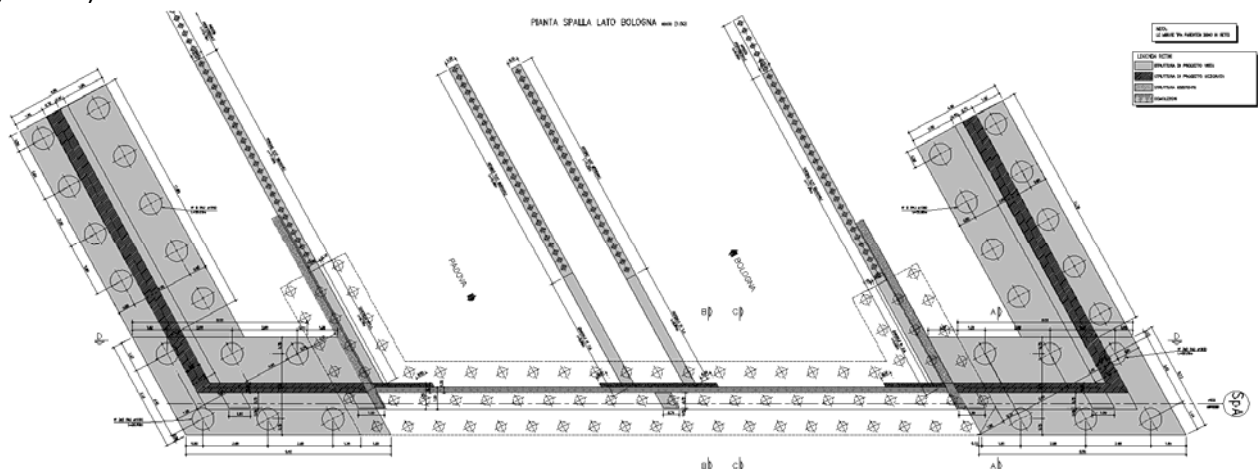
Pianta con localizzazione tiranti a tergo spalla
